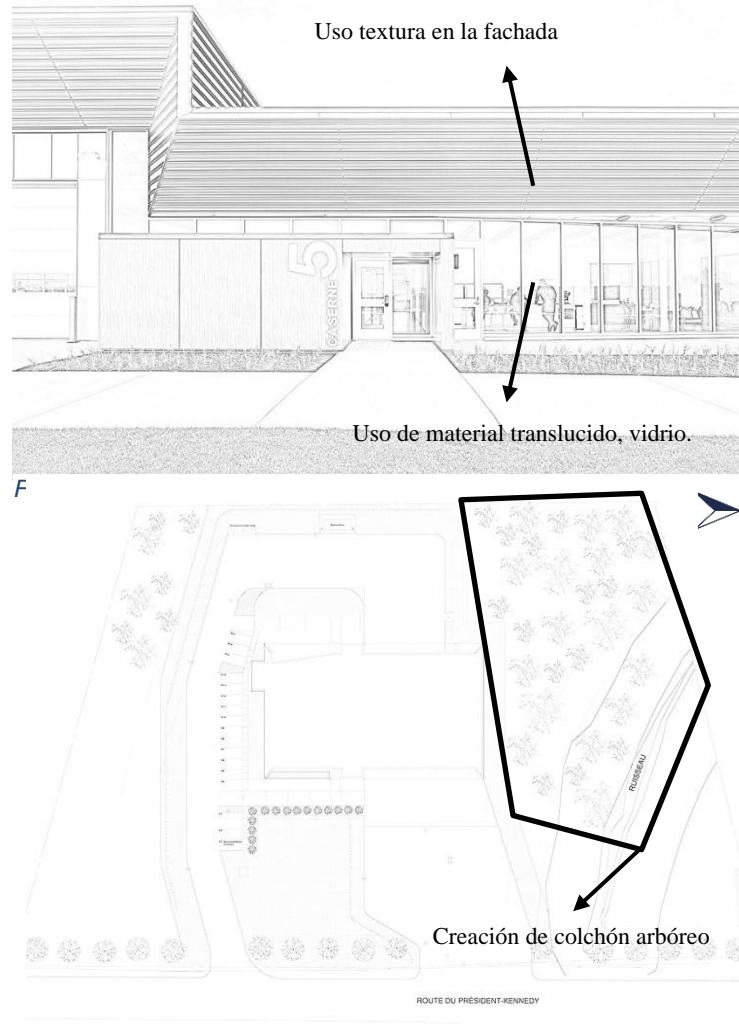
Plano de emplazamiento. CCM y STGM Architectes (2016)
